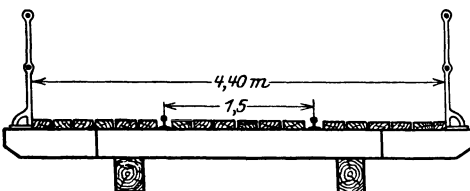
Querschnitt einer Eisenbahnbrücke mit Hauptträgern und Brückenschwellen.
